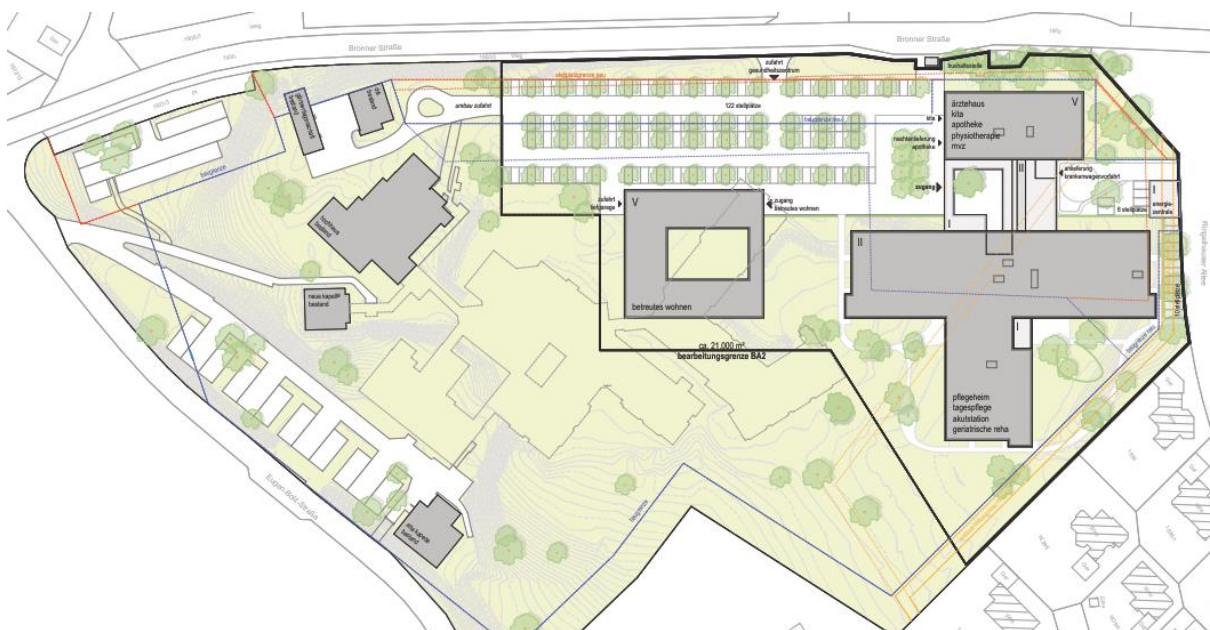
Lageplan, Bauabschnitt 2 des Gesundheitszentrums Laupheim (Süden-links, Norden-rechts); architekten BDA mühlich, fink & partner, Ulm
